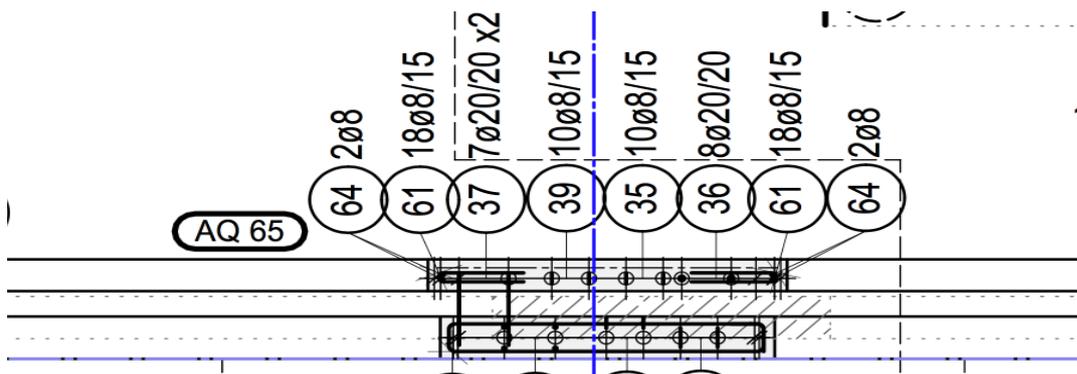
Bewehrung Grundriss der Fassade 6
